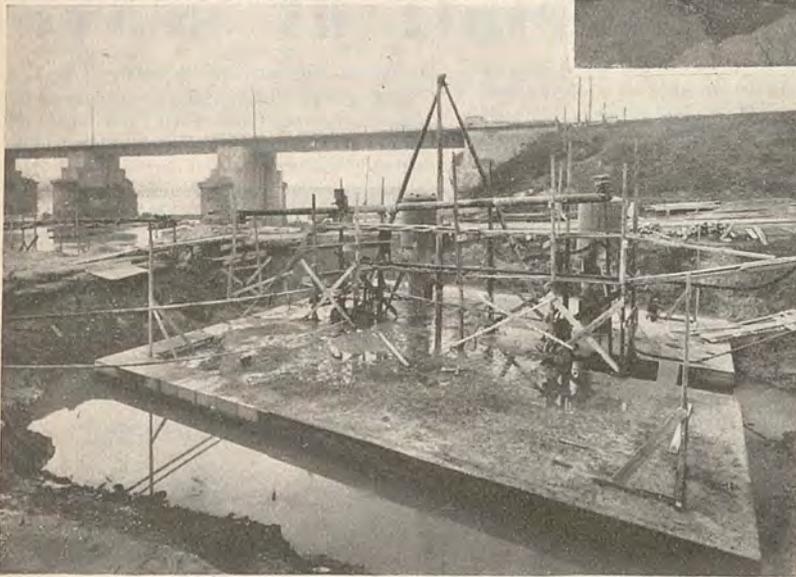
Le pompe applicate al cassone di spalla in affondamento.
